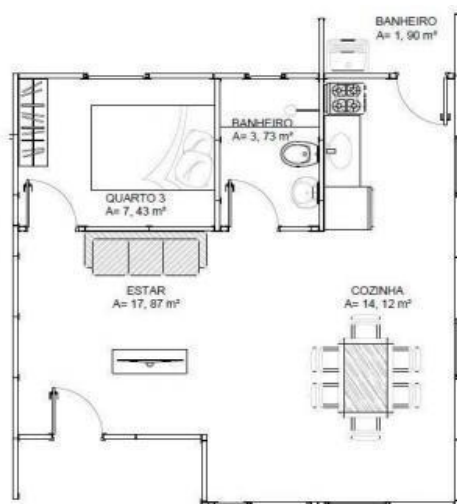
Núcleo principal da Casa Concreto PVC, com alterações de modulação. Fonte: Elaborado pelo autor.
